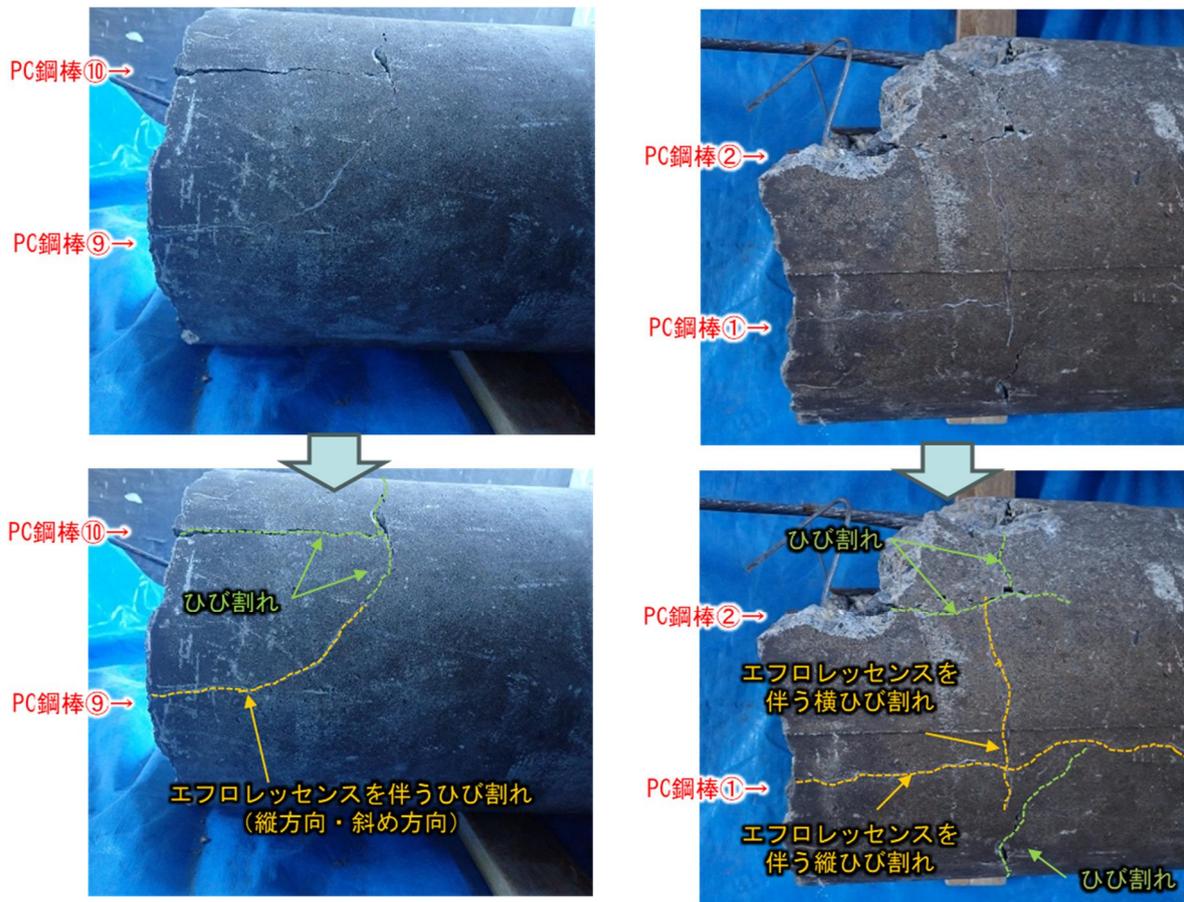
地際の折損部周辺のコンクリートのひび割れ
